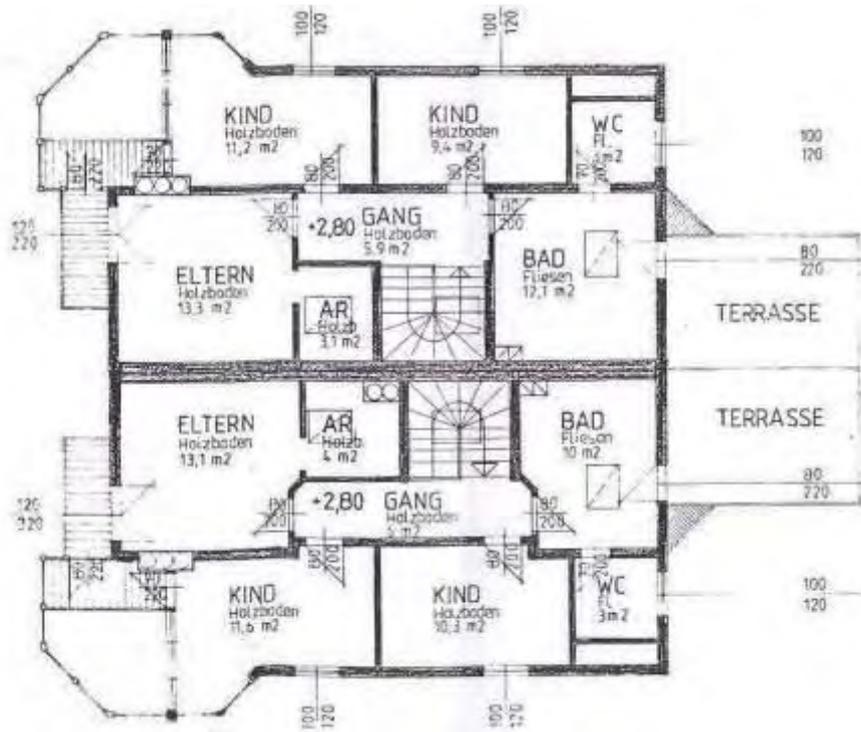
Grundriss Dachgeschoß „Haus K.“
